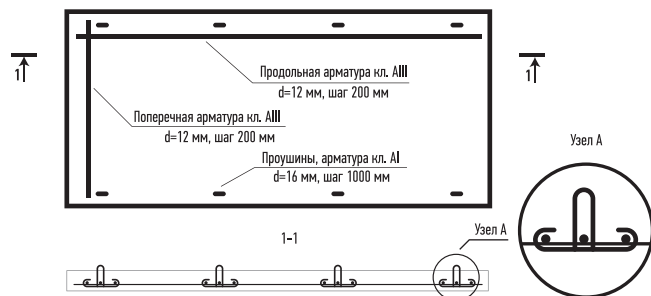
Схема армирования плиты для горизонтальных емкостей
